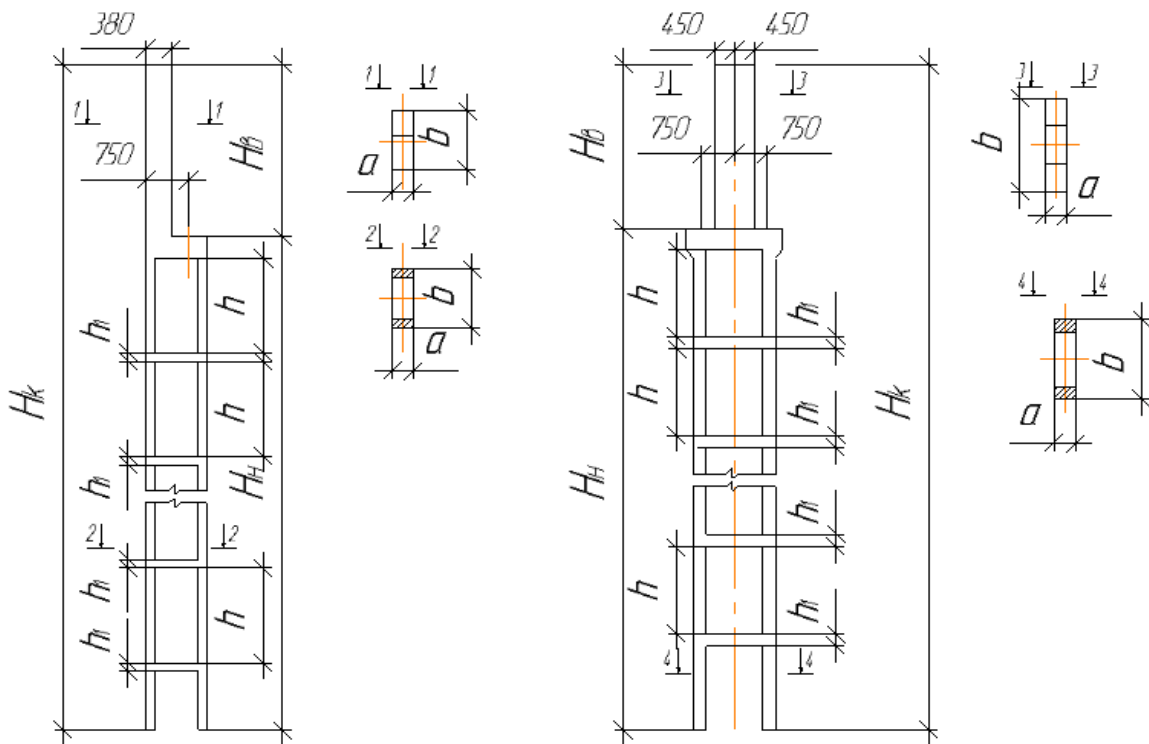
Залізобетонні колони по серії 1.424.1-10
